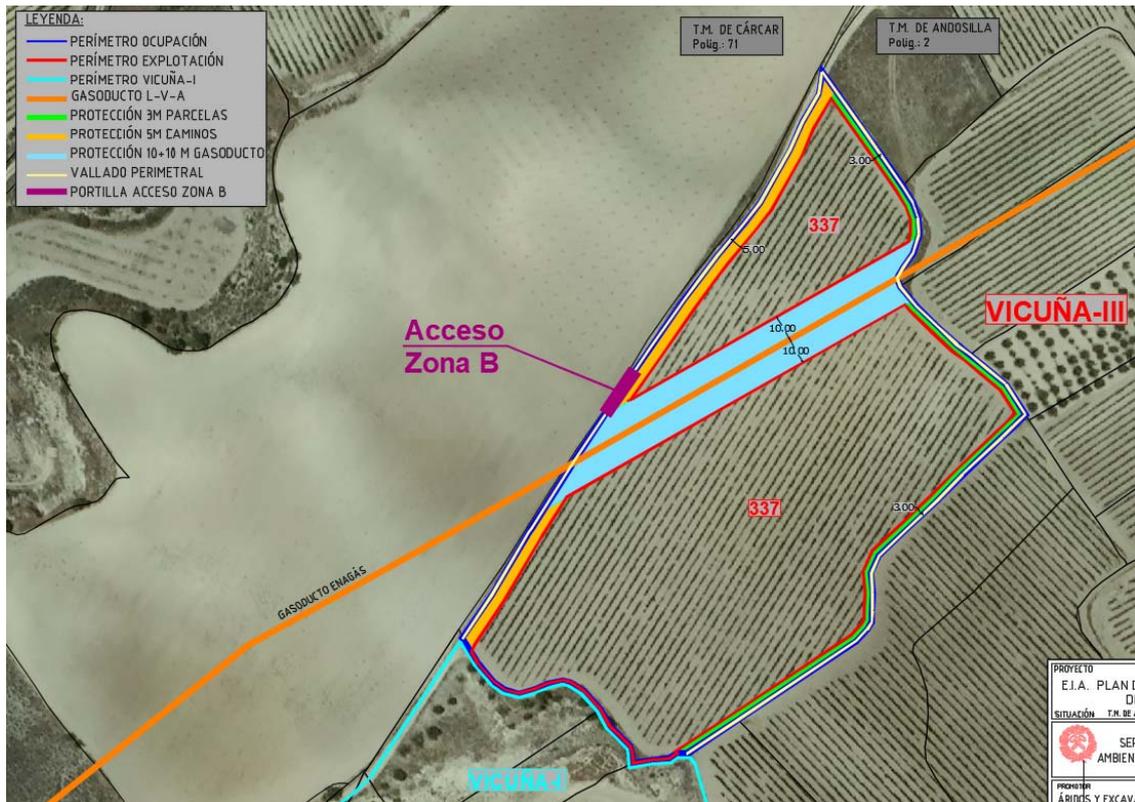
Extracto del plano nº 6 Zonas de protección y perímetros.
